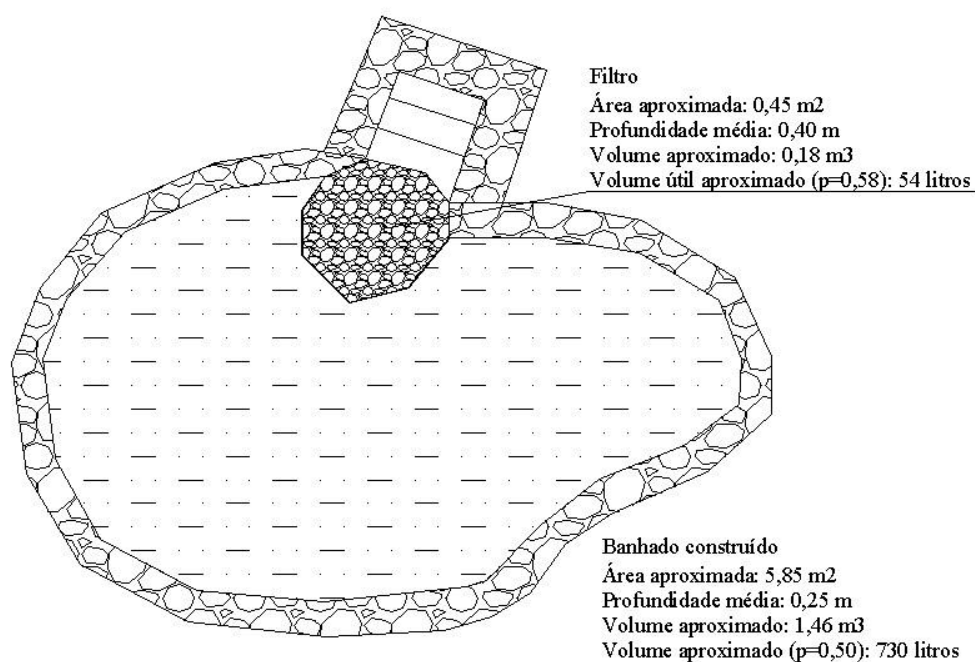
Esboço do Sistema 1, Piloto de Banhado Construído - BC (wetland).
